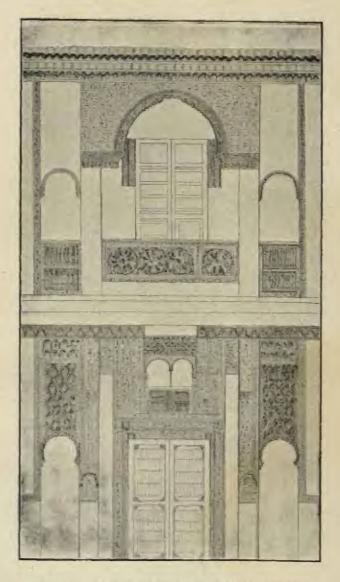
Plan en élévation de la façade S. de l'atrium.
